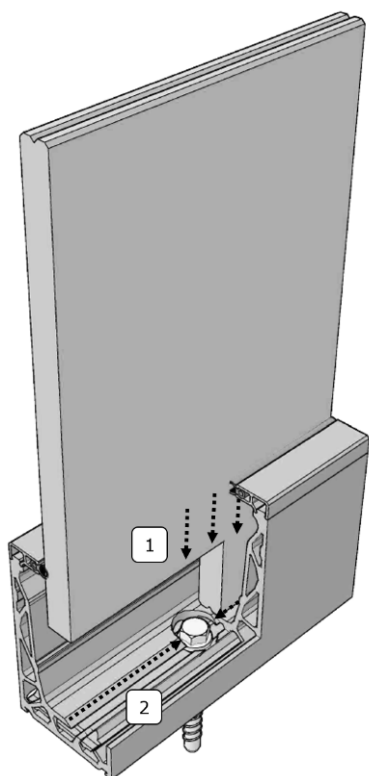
Exemple d'installation avec drainage du profilé et de la dalle
